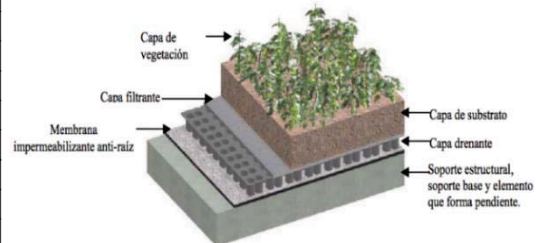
Detalle de azotea naturada. Fuente: www.hildebrandt.cl
